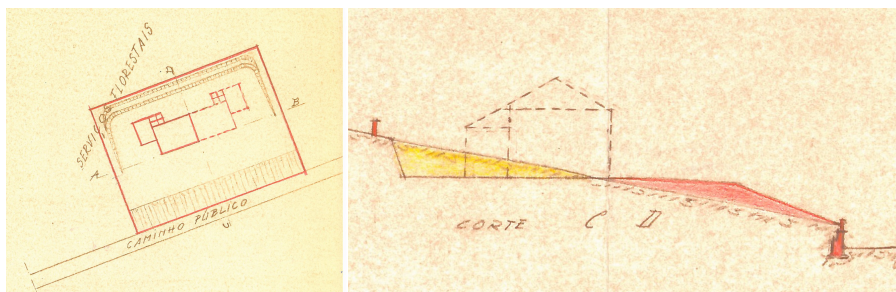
Projeto original para a Escola Primária de Rio de Onor, planta e corte transversal
